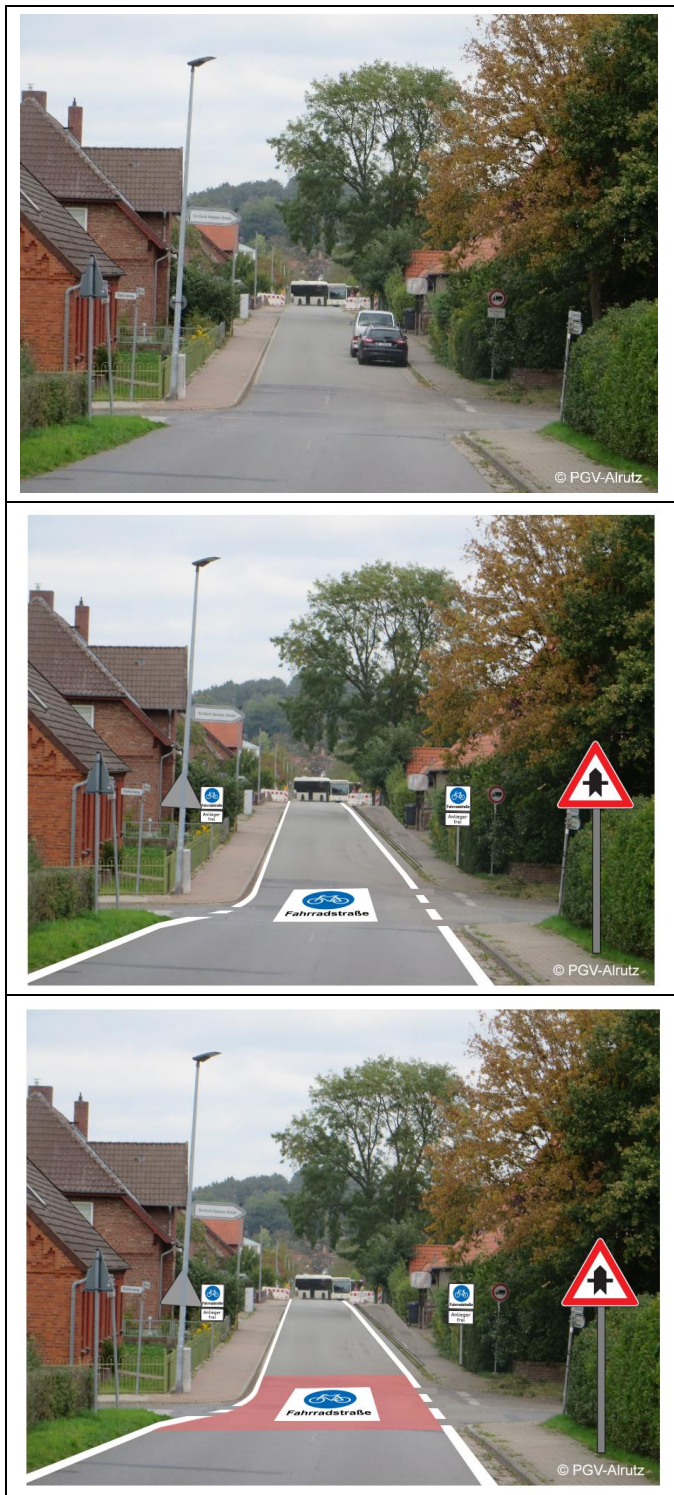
Kennzeichnung Fahrradstraße im Streckenverlauf mit Umgestaltungsvorschlag Einmündung Bauernstraße
